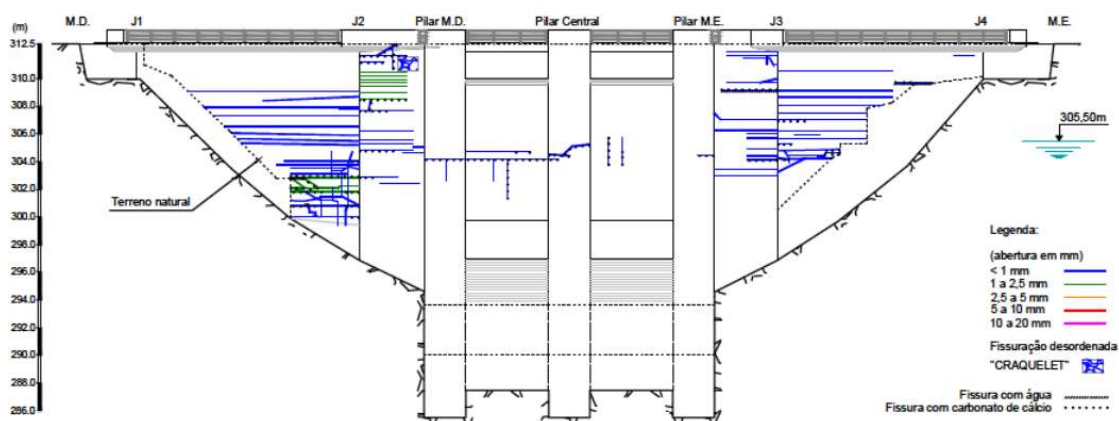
Levantamento da fissuração no alçado de montante da barragem de Fagilde, em outubro de 2004 (retirado de (LNEC, 2006)).
